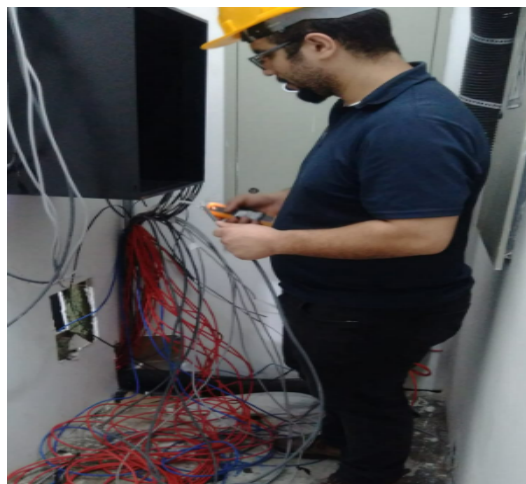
Implantação de estrutura de rede, condutores verticais.
